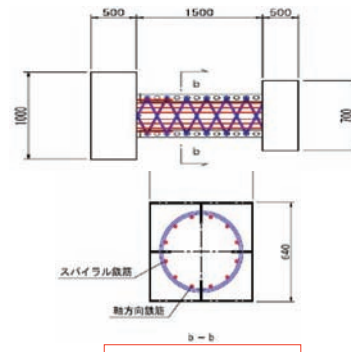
PC桁・鋼桁接合部の一般図と中詰めコンクリート部の断面図
